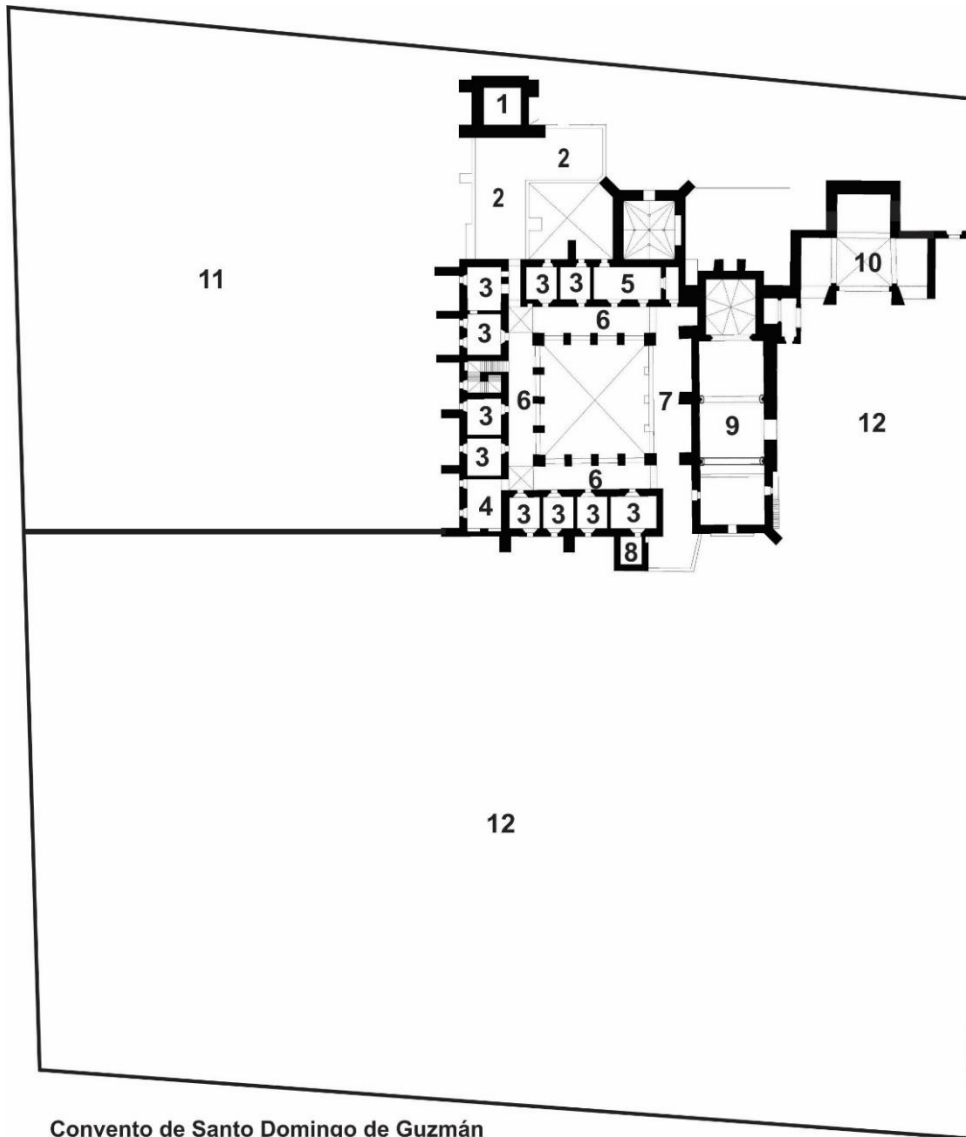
Reconstrucción hipotética de la planta de conjunto y planta baja del convento de Santo Domingo Tehuantepec. c. 1555. Levantamiento arquitectónico y propuesta de distribución de espacios del autor.
